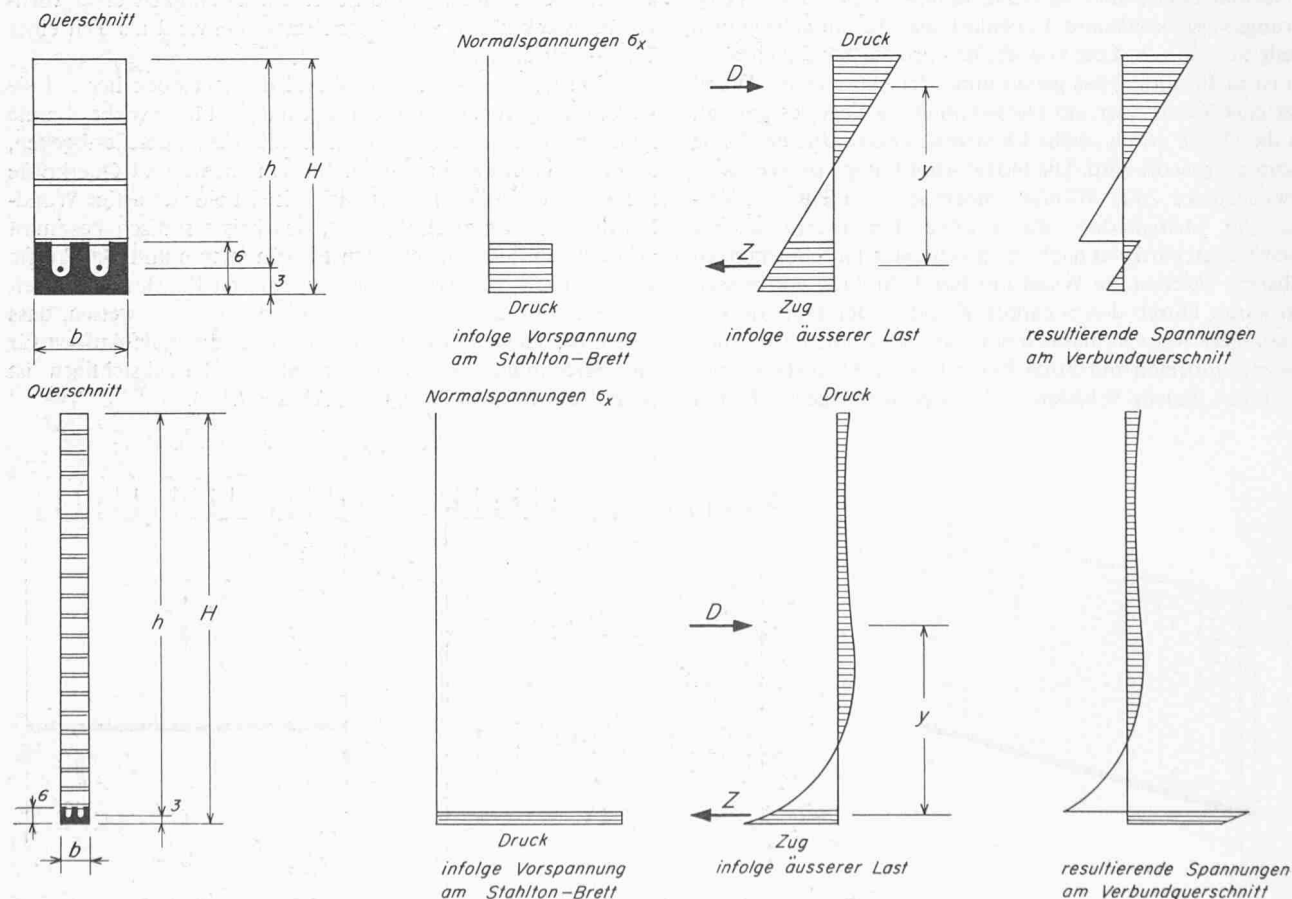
Oben: Spannungsverteilung in niedrigen (balkenartigen) Trägern; unten: Spannungsverteilung in hohen (wandartigen) Trägern
